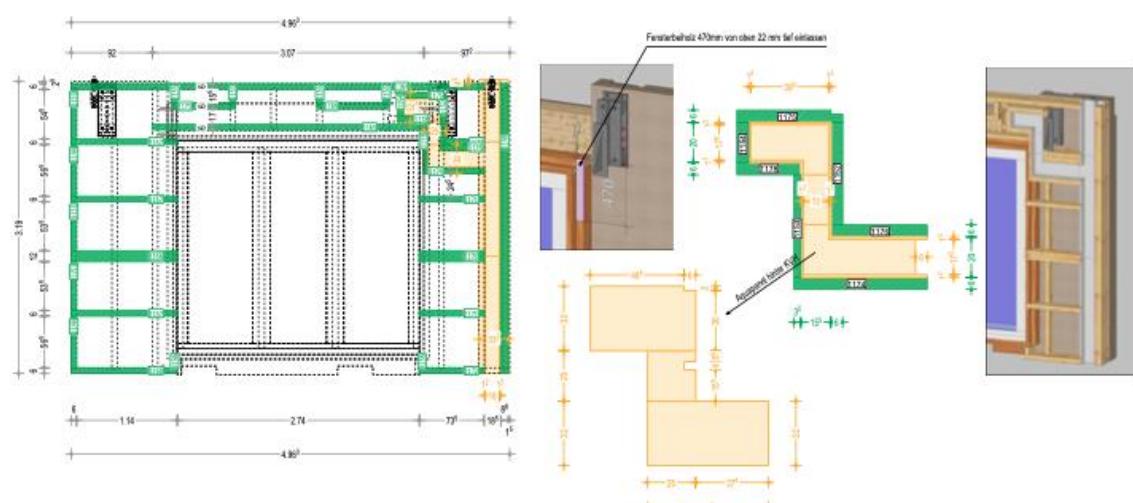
Werkplanung Wandelement, Entwässerung – Verfasser: Prause Holzbauplanung, Lindlar (D)
